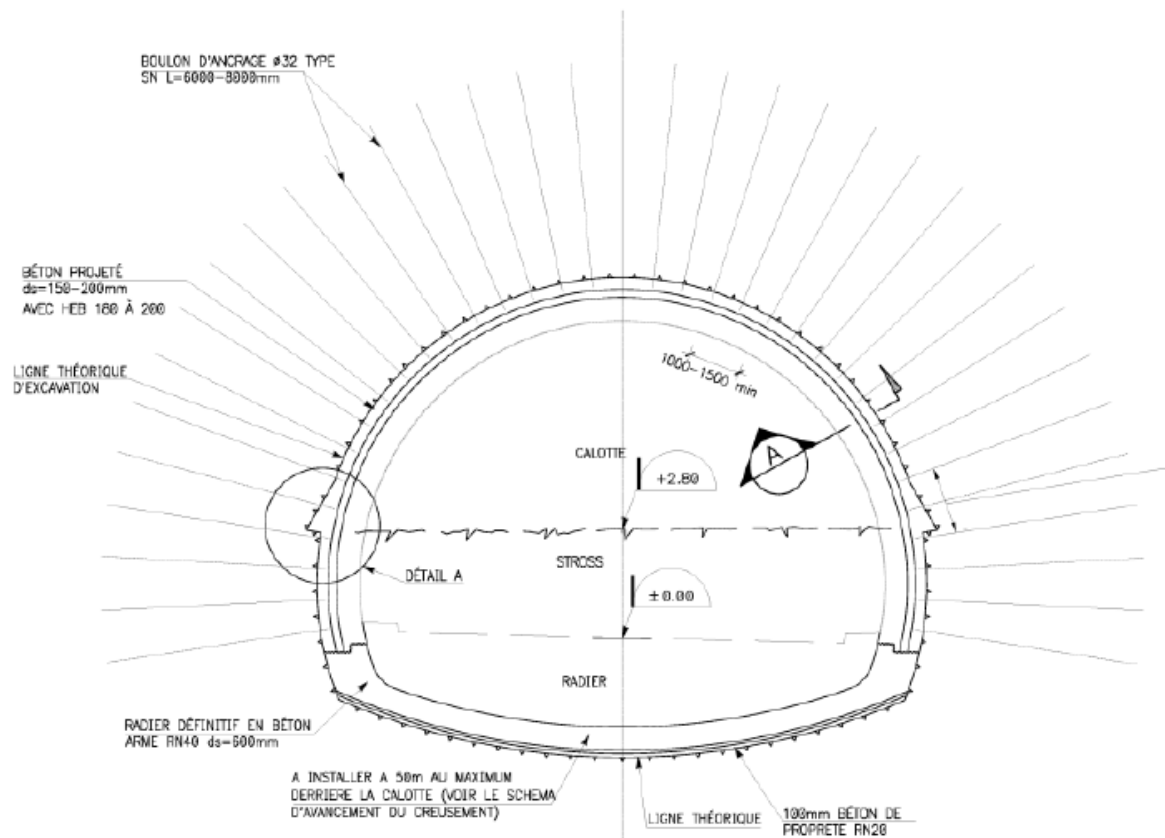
Coupe transversale du soutènement provisoire classe B
